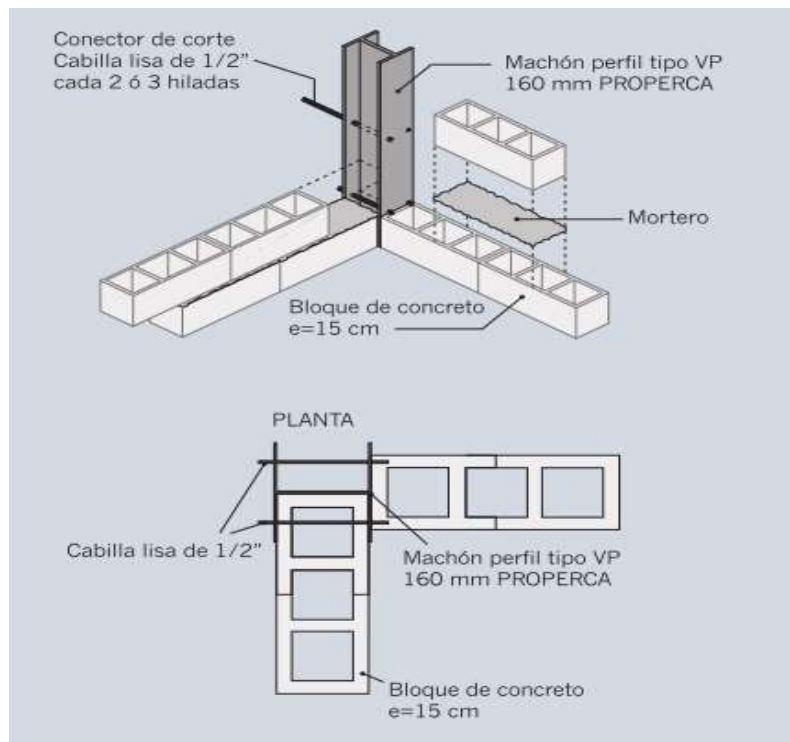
Vista en planta de conexión marco-muro para bloque de concreto. (Acosta [15])
